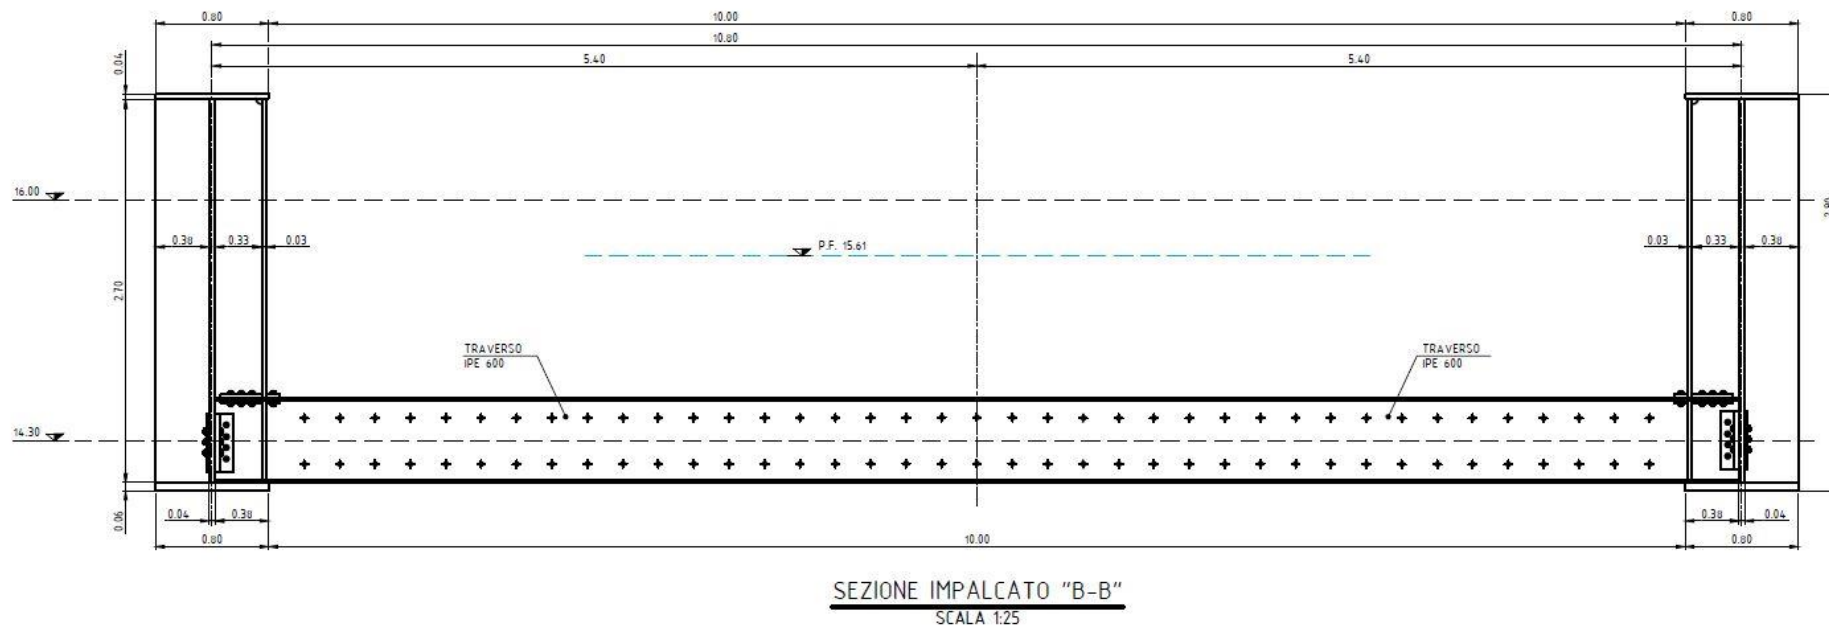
Sezione trasversale dettagliata dell'impalcato
